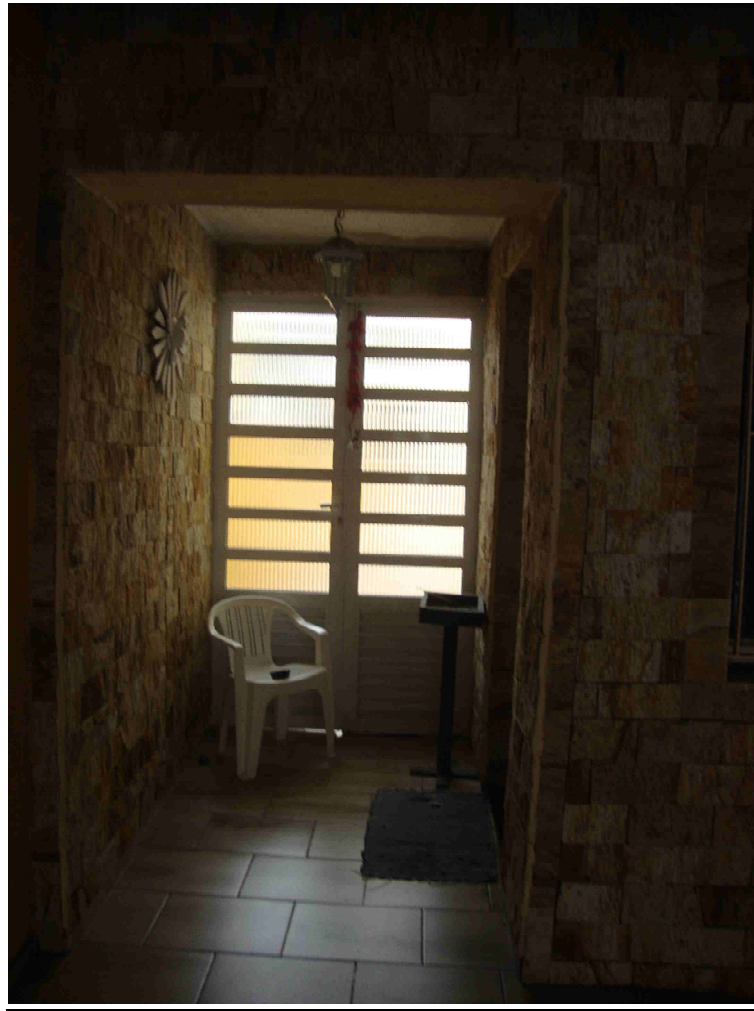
Aspectos da área de garagem (pavimento inferior).
